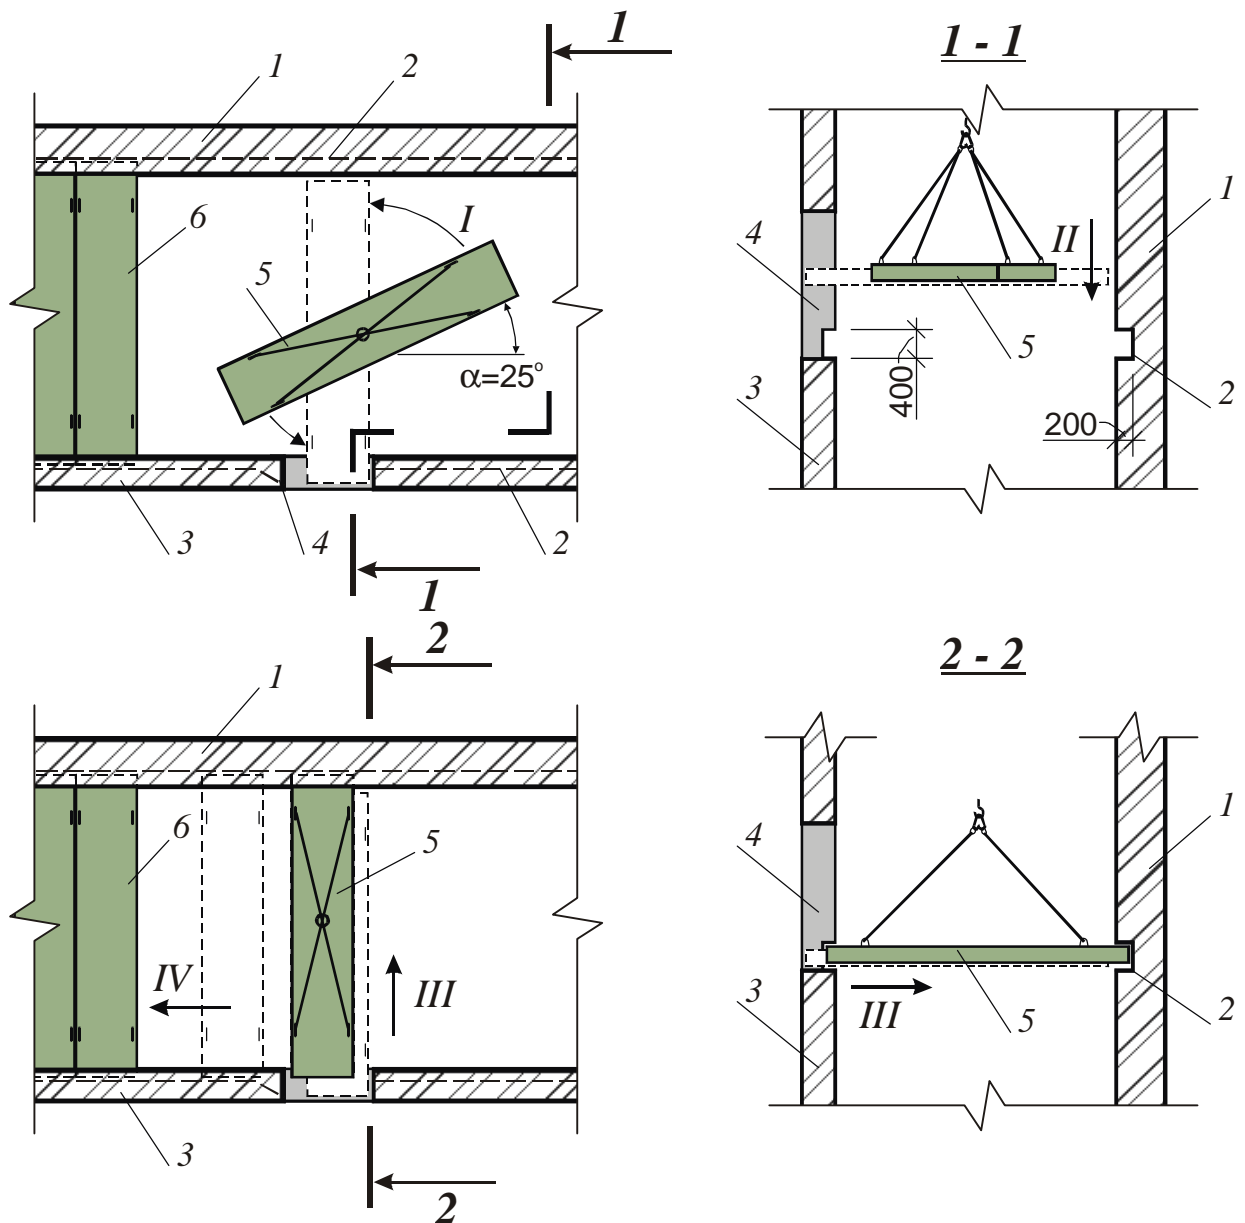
Монтаж многопустотных панелей с использованием проемов в стене:
